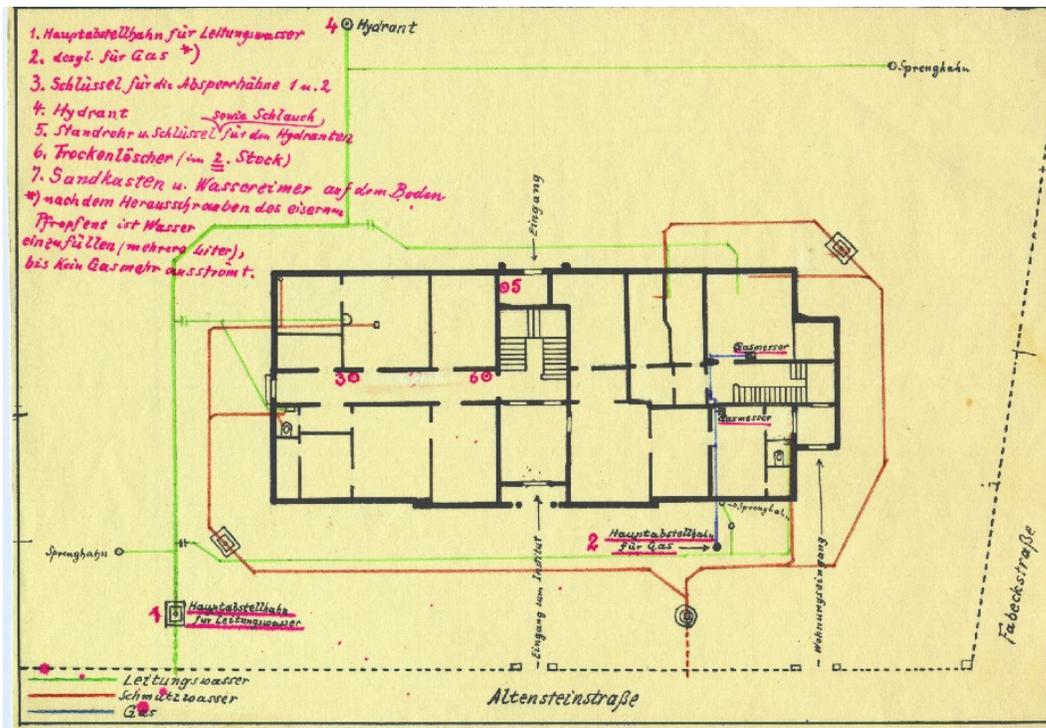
Anlage zum Betriebsluftschutzplan des Astronomischen Rechen-Instituts von 1938. Der Plan zeigt den Grundriß des Institutsgebäudes in Berlin-Dahlem, Altensteinstraße 40 (Erdgeschoß). Farbiger markiert sind die für den Luftschutz wichtigen Positionen. Der Haupteingang zum Institutsgebäude befindet sich in der Mitte der Hausfront zur Altensteinstraße. Der Nebeneingang zu den Wohnungen liegt rechts in Richtung Fabbeckstraße.
